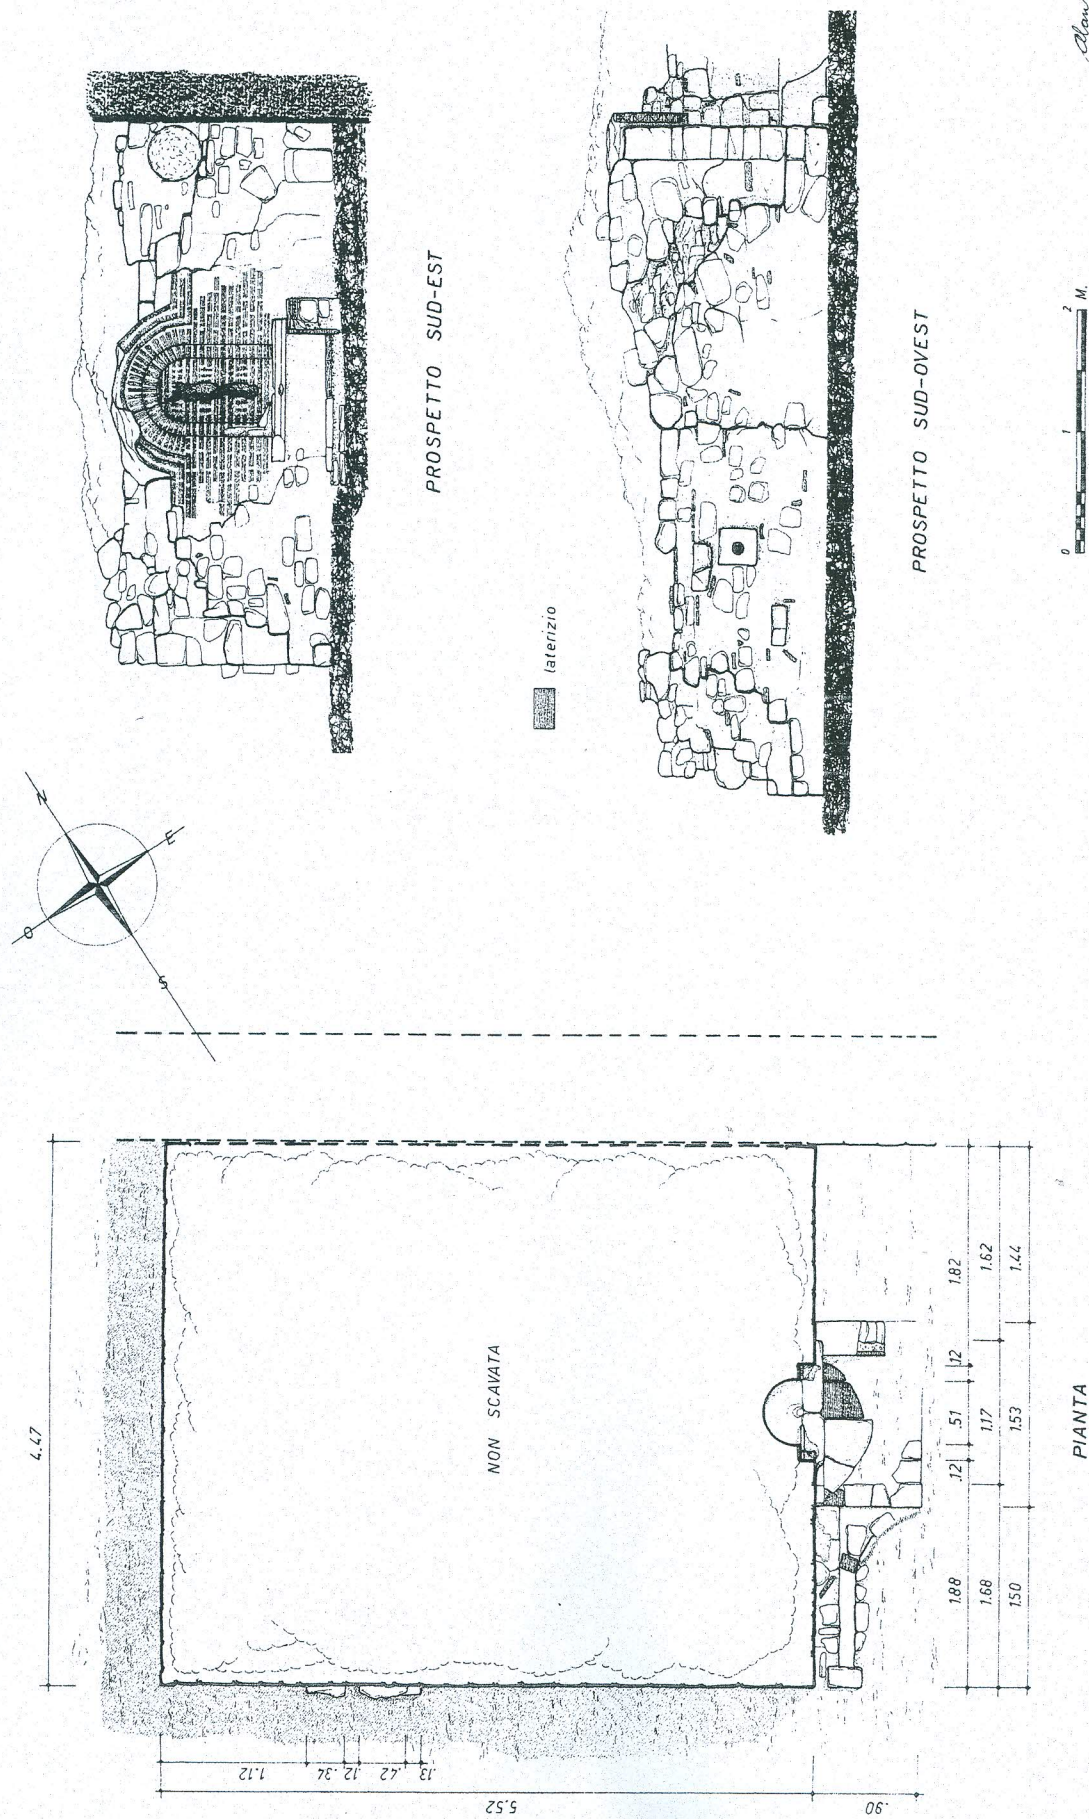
PIANTE E PROSPETTI SUD-EST E SUD-OVEST DELLA FONTANA BIZANTINA N. 2 (rilievo arch. A. Ortega).
